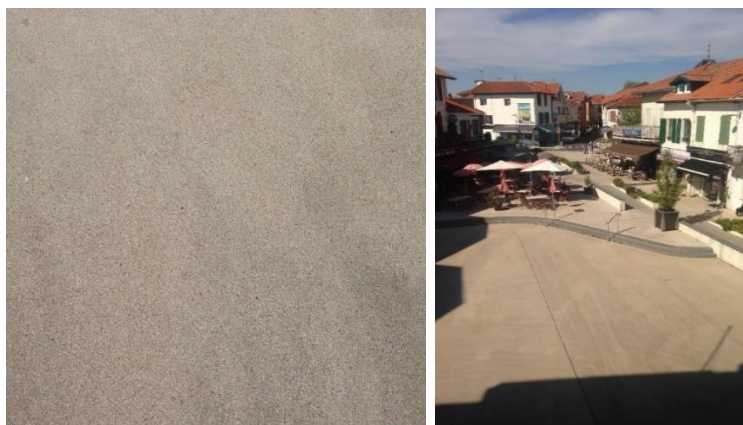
revêtement au sol place de l'Hôtel de Ville de Capbreton
